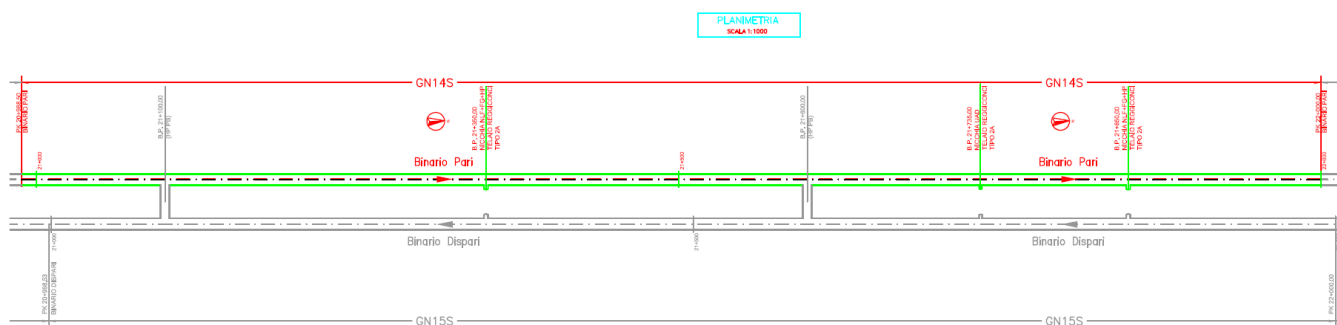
Planimetria scavo meccanizzato – WBS GN14S
